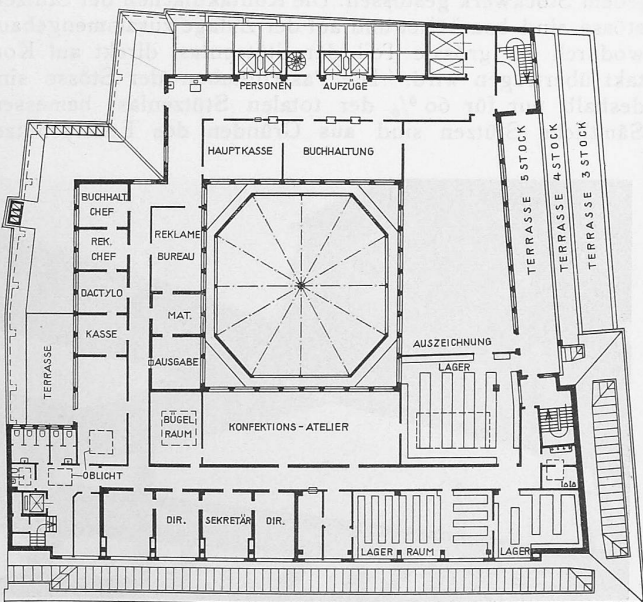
5. Geschoss (Dachgeschoss). — Masstab 1 : 600.
